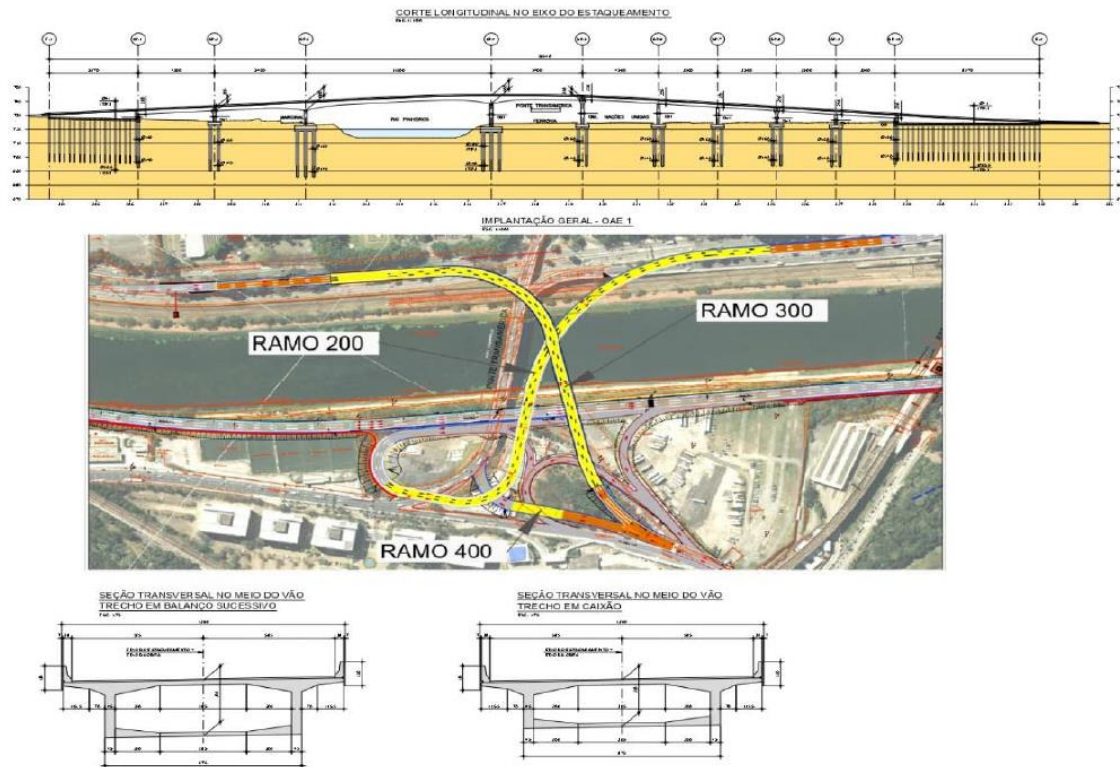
Trecho ponte Transamérica e perfil, objeto de intervenção.
